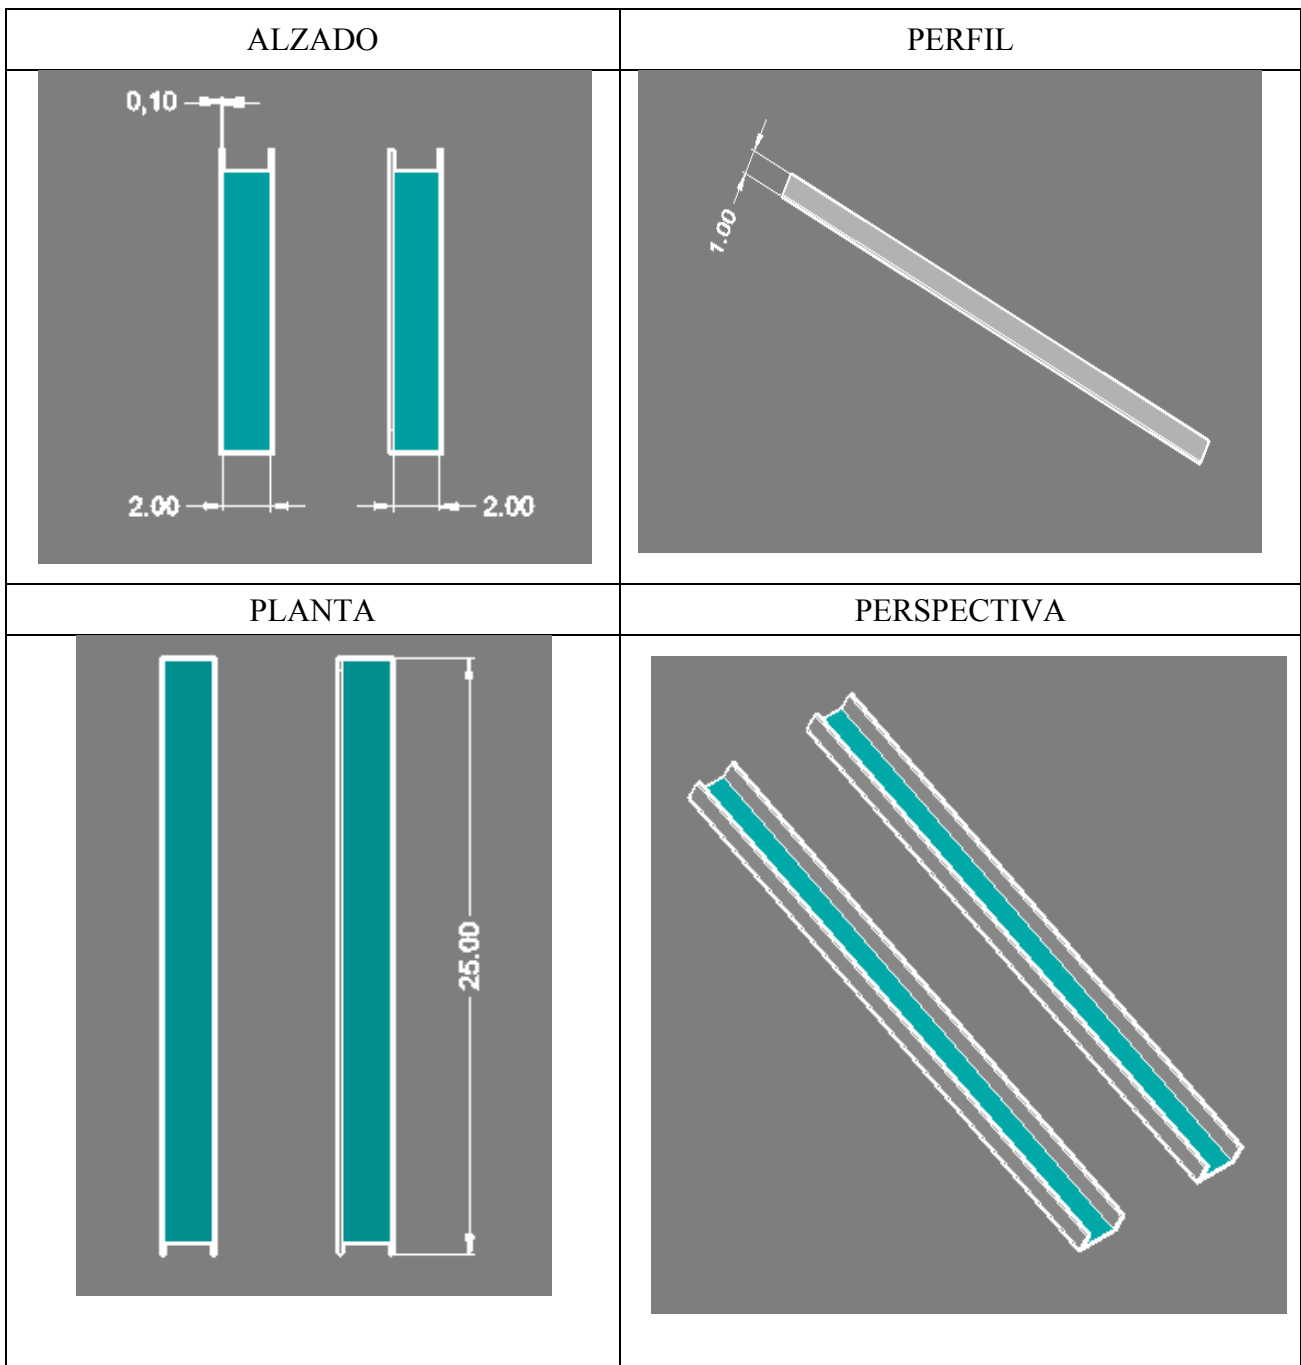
Ficha técnica (alzado, perfil, planta y vista en perspectiva *SO*) del drenaje con pequeños canales transversales (alternativa B).
